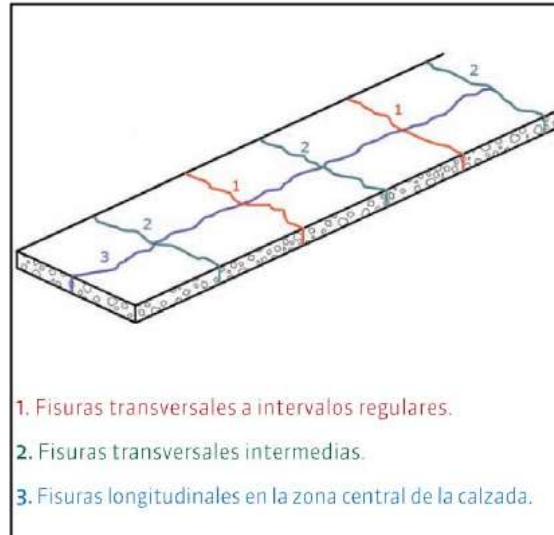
Fisuración natural del pavimento (fuente: ICPA).
